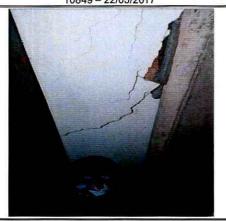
Condiciones muro divisorio predio 2. Tomada de DI-10849 – 22/05/2017
